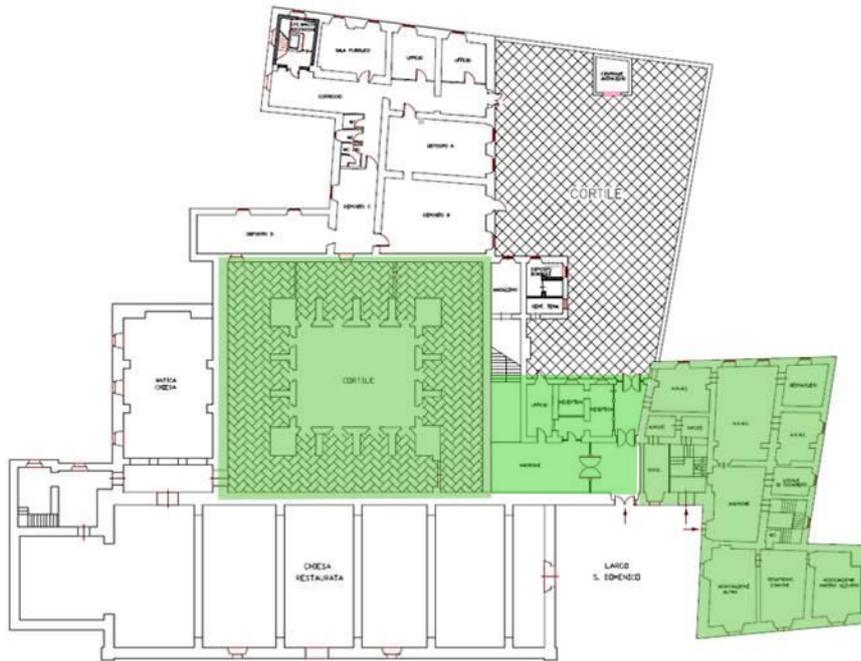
Pianta piano terra della porzione di immobile oggetto della procedura
